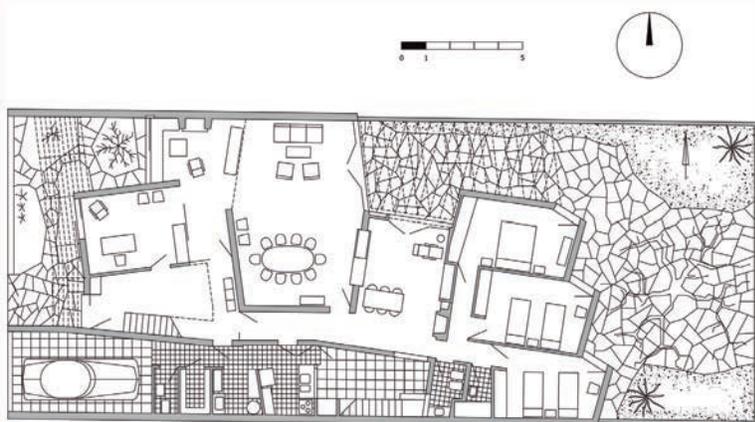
Planta de la casa del Dr. Hidalgo (fuente: Elaboración propia, 2011).
